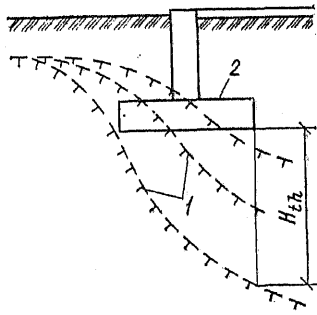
Схема перемещения верхней границы слоя вечномёрзлого грунта в процессе его оттаивания под фундаментом наружной стены
